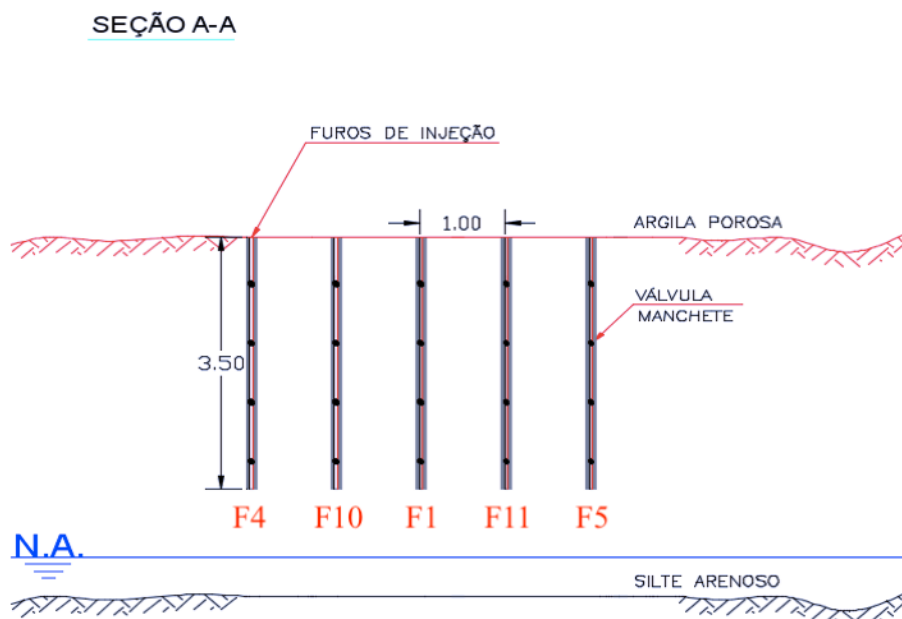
Vista da seção A-A do arranjo das injeções. Dimensões em m.
